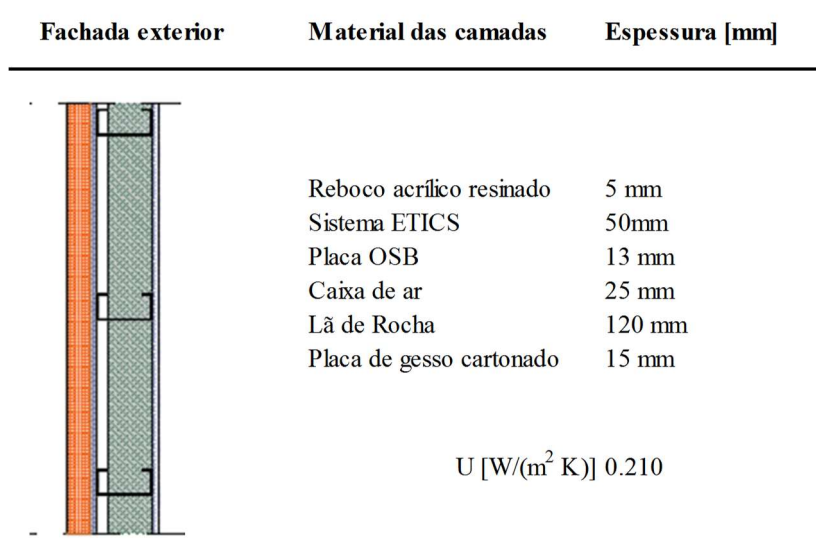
Pormenor construtivo e propriedades da fachada exterior
